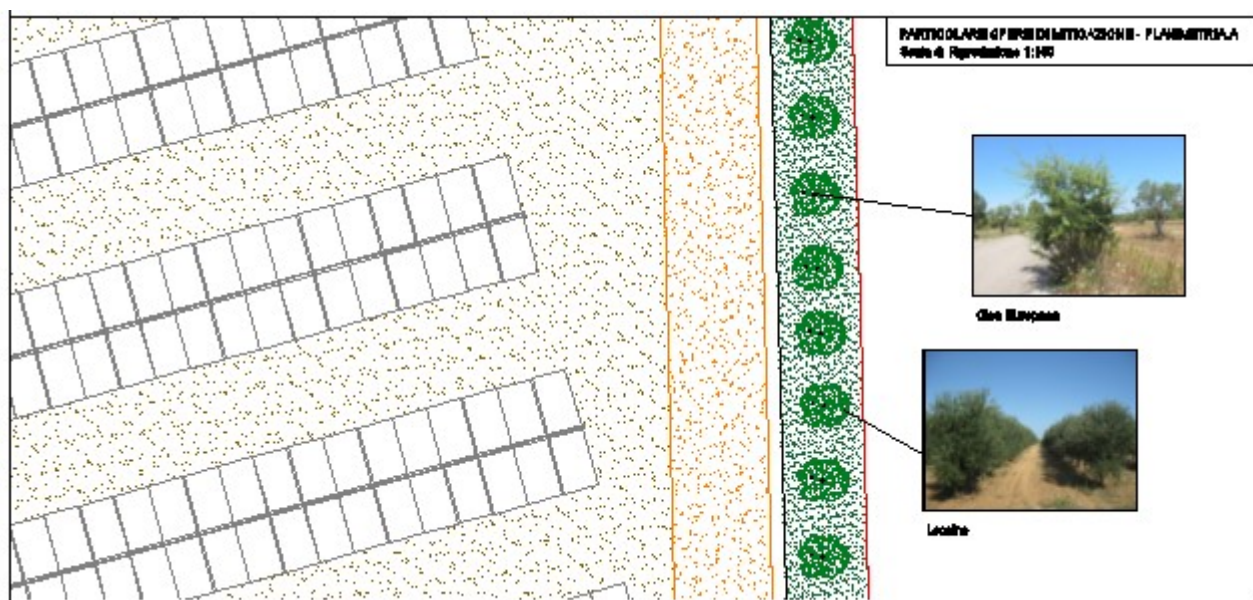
Opere di Mitigazione (Vista in Pianta)
